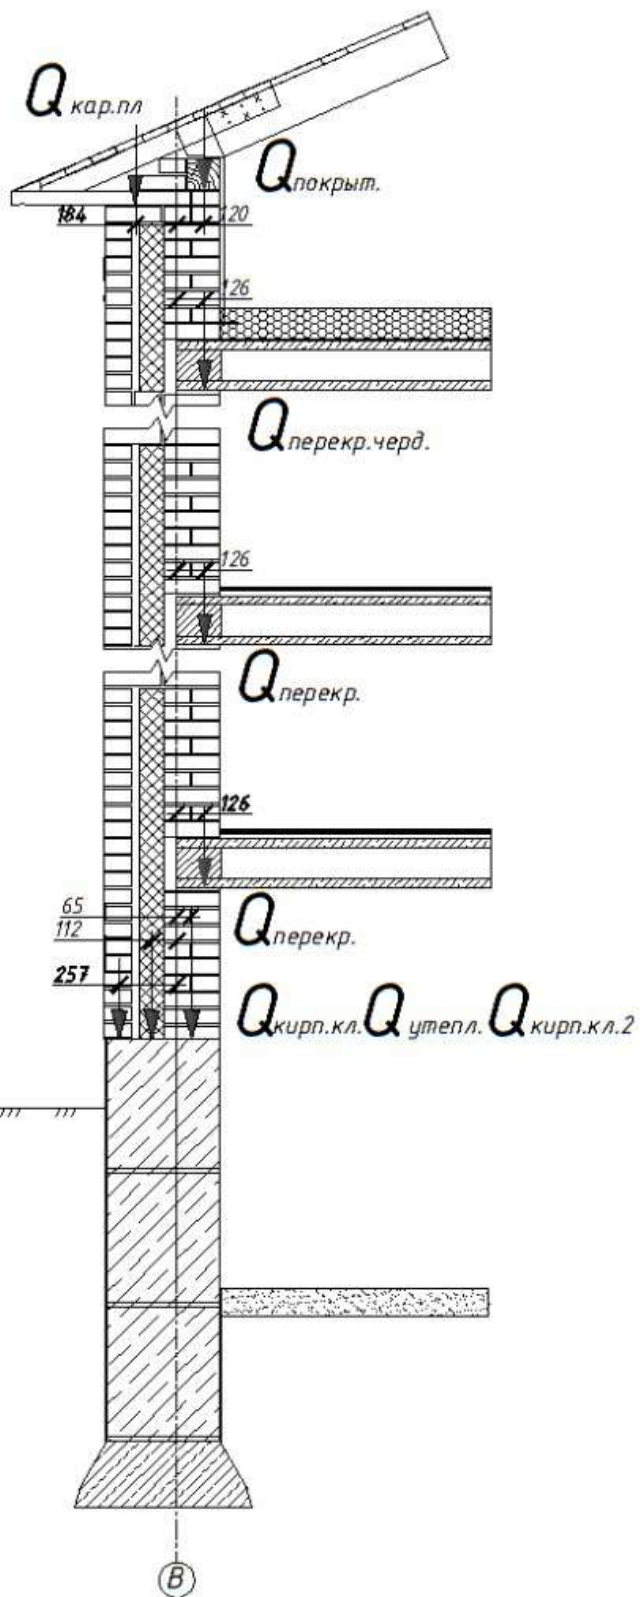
Схема к определению момента, действующего на фундамент под наружную стену.
